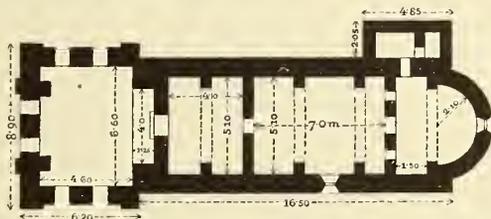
Grundriss der Kirche von Dobrun.
